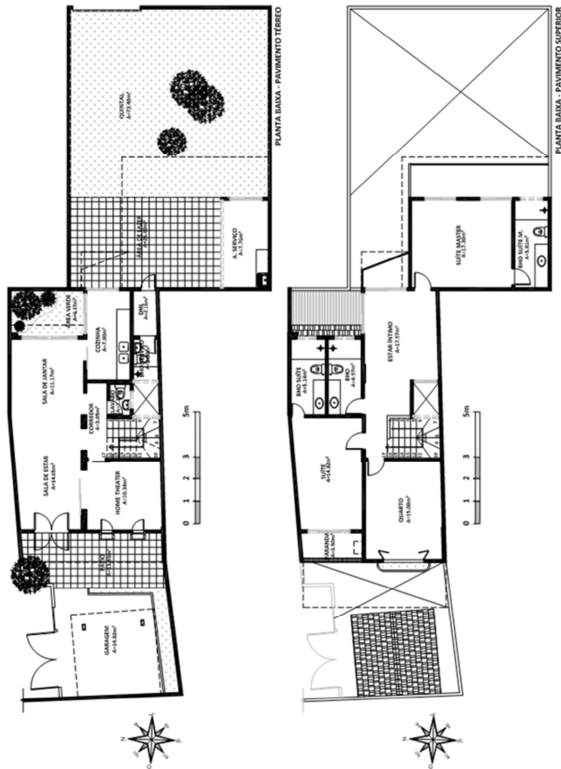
Planta baixa da edificação – Situação proposta (Fonte: Larissa Amaral).
